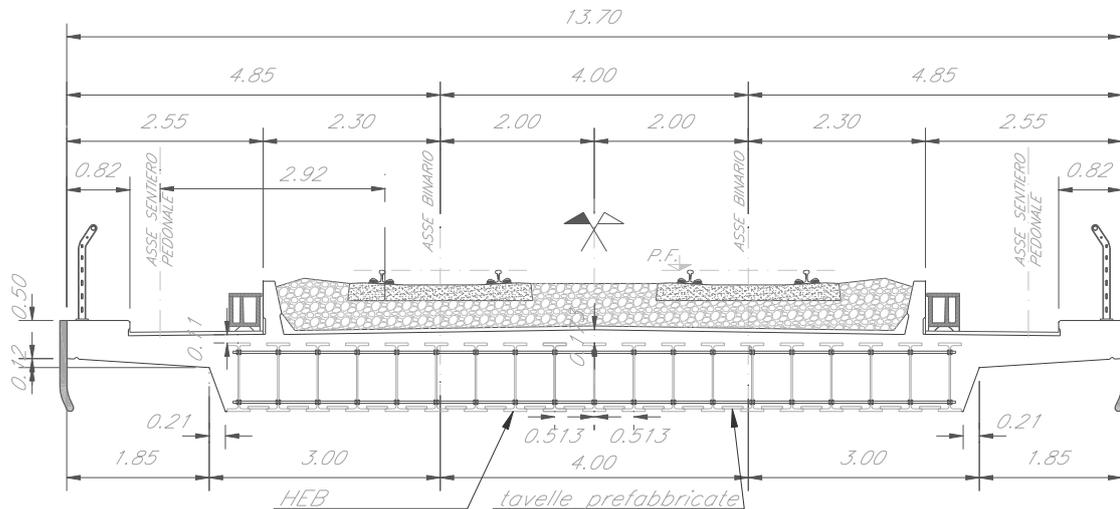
Sezione tipo ferroviaria impalcato a travi incorporate a DB
